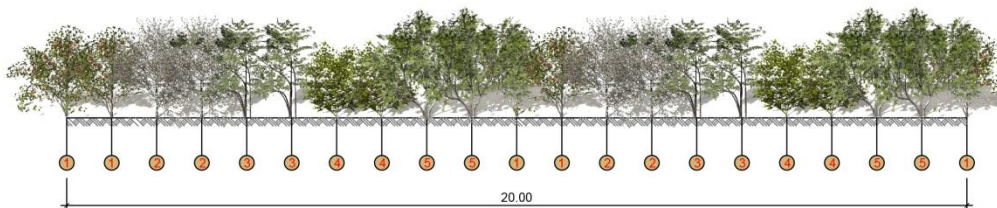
Prospetto piantumazione perimetrazione bacini PI-PB
